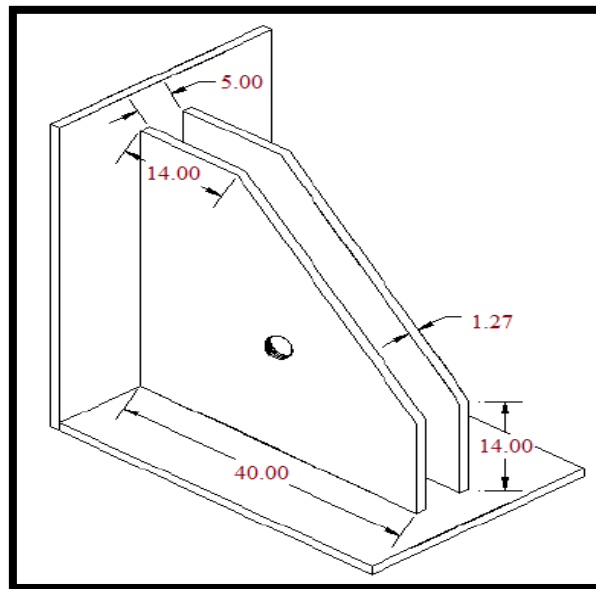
Propuesta del detalle en cm de las cartelas metálicas. Fuente: Propia
